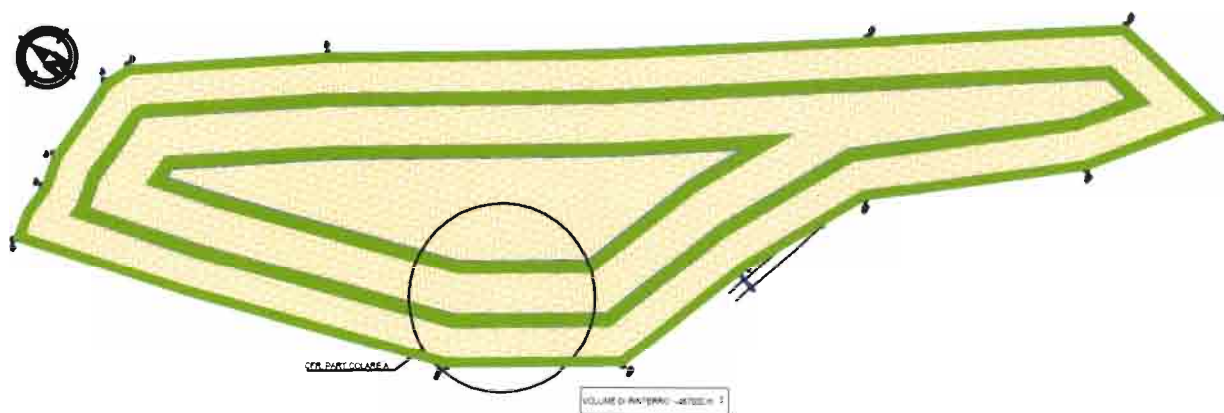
Planimetria di ripristino presso il sito di deposito Plattner
